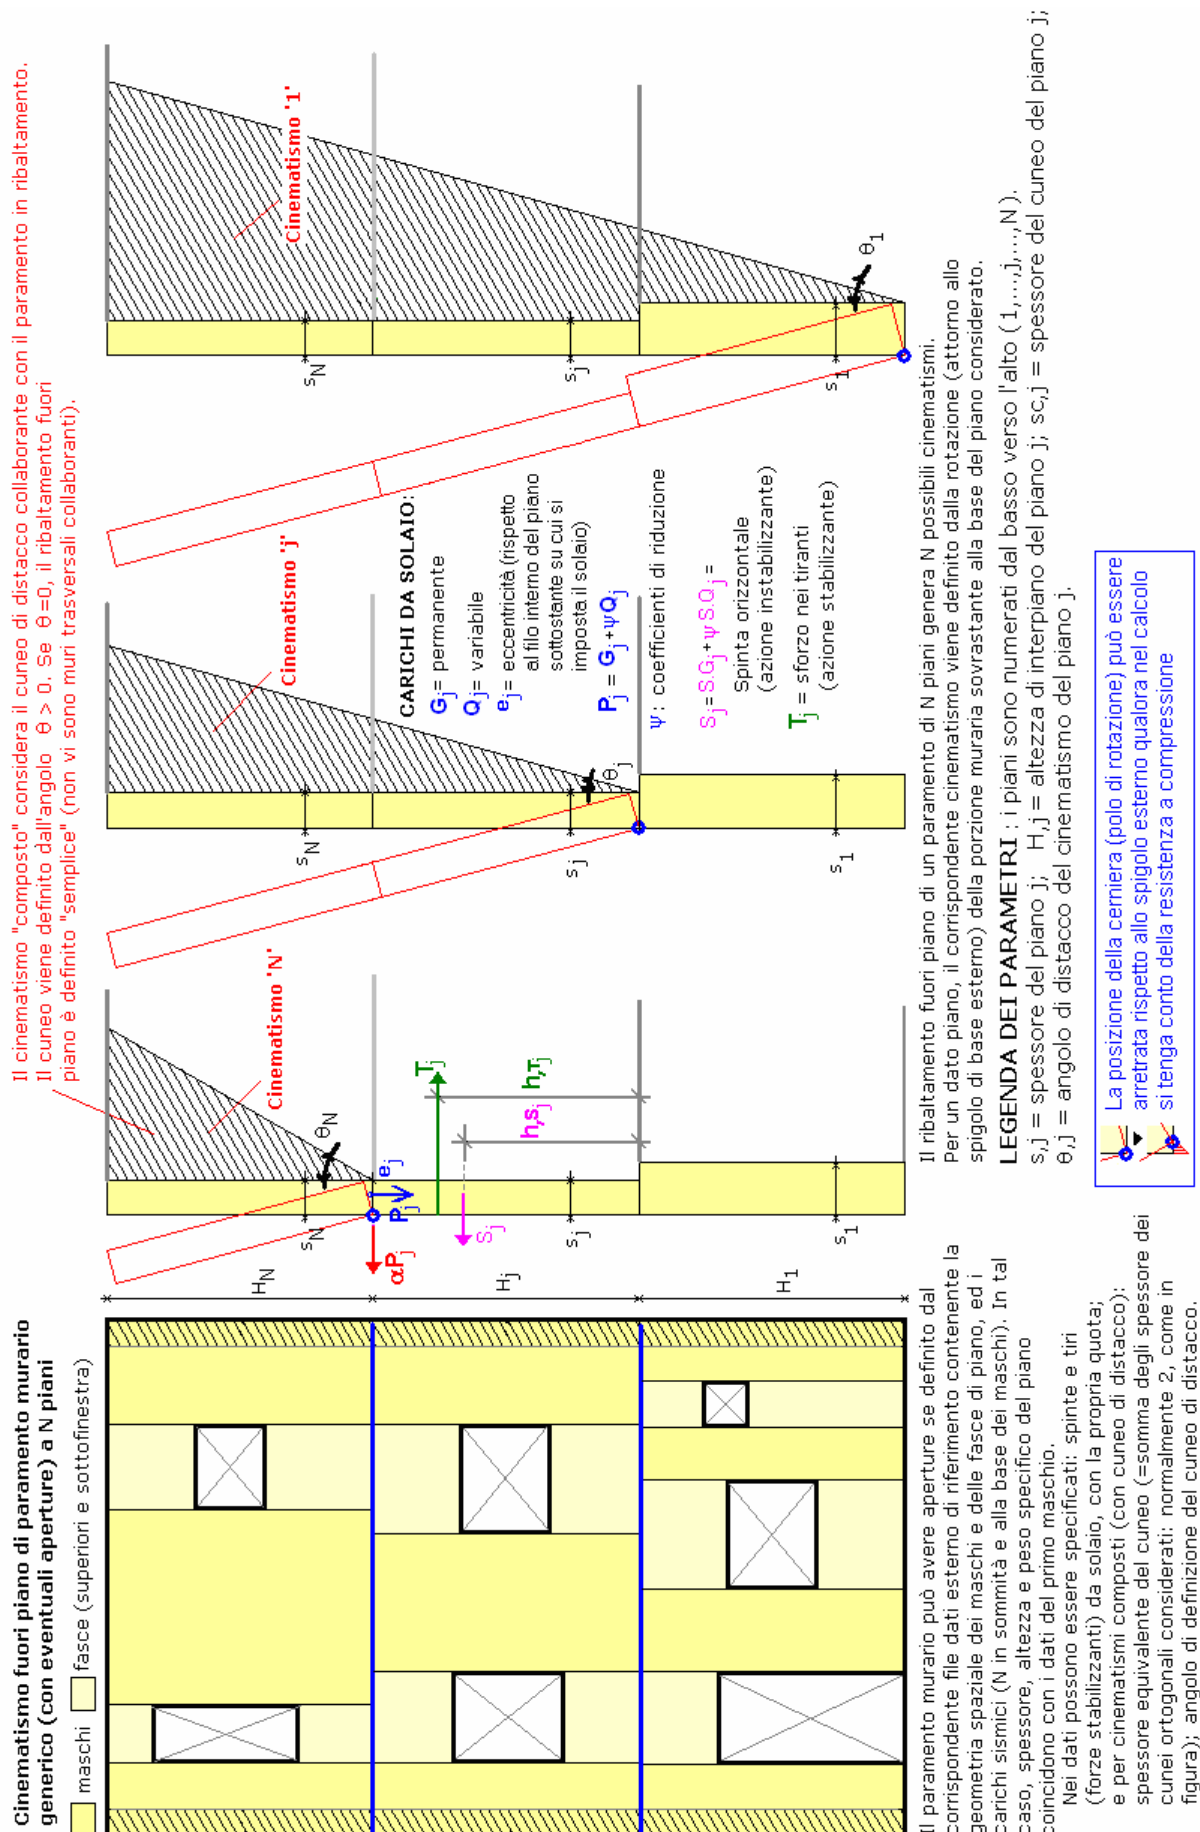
101-108. Paramento murario a N piani (fuori piano) (N da 1 a 8)
